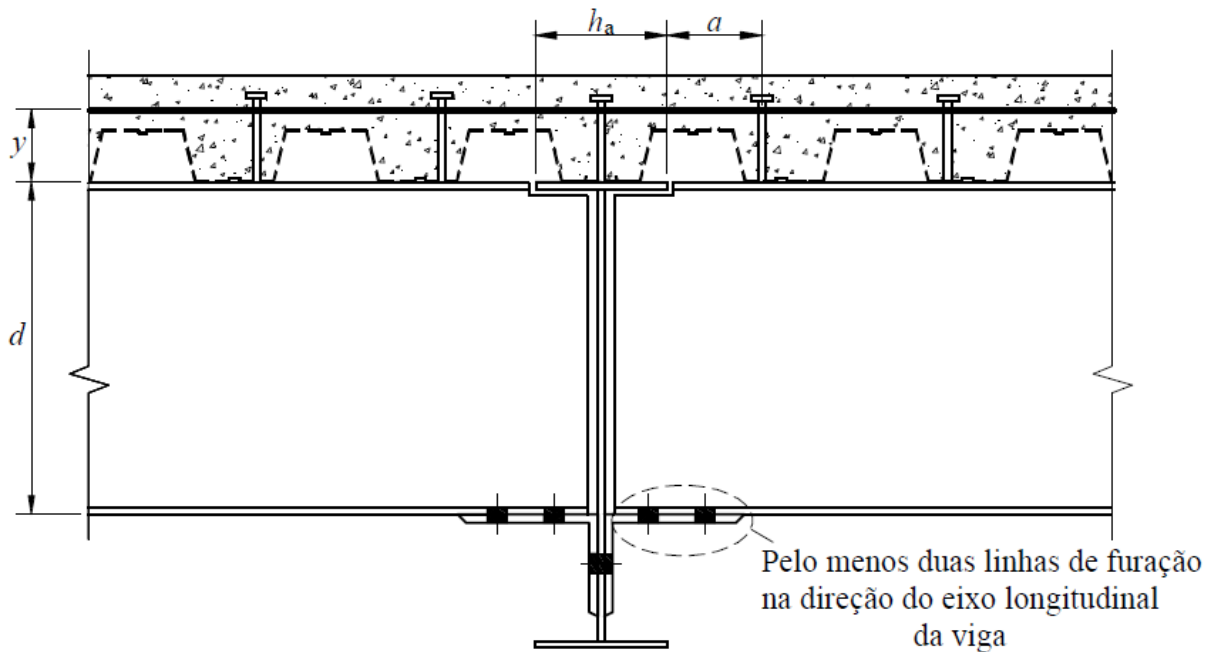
Ligação mista com cantoneiras parafusadas na alma e na mesa inferior da viga apoiada. Fonte: ABNT NBR 8800:2008.
